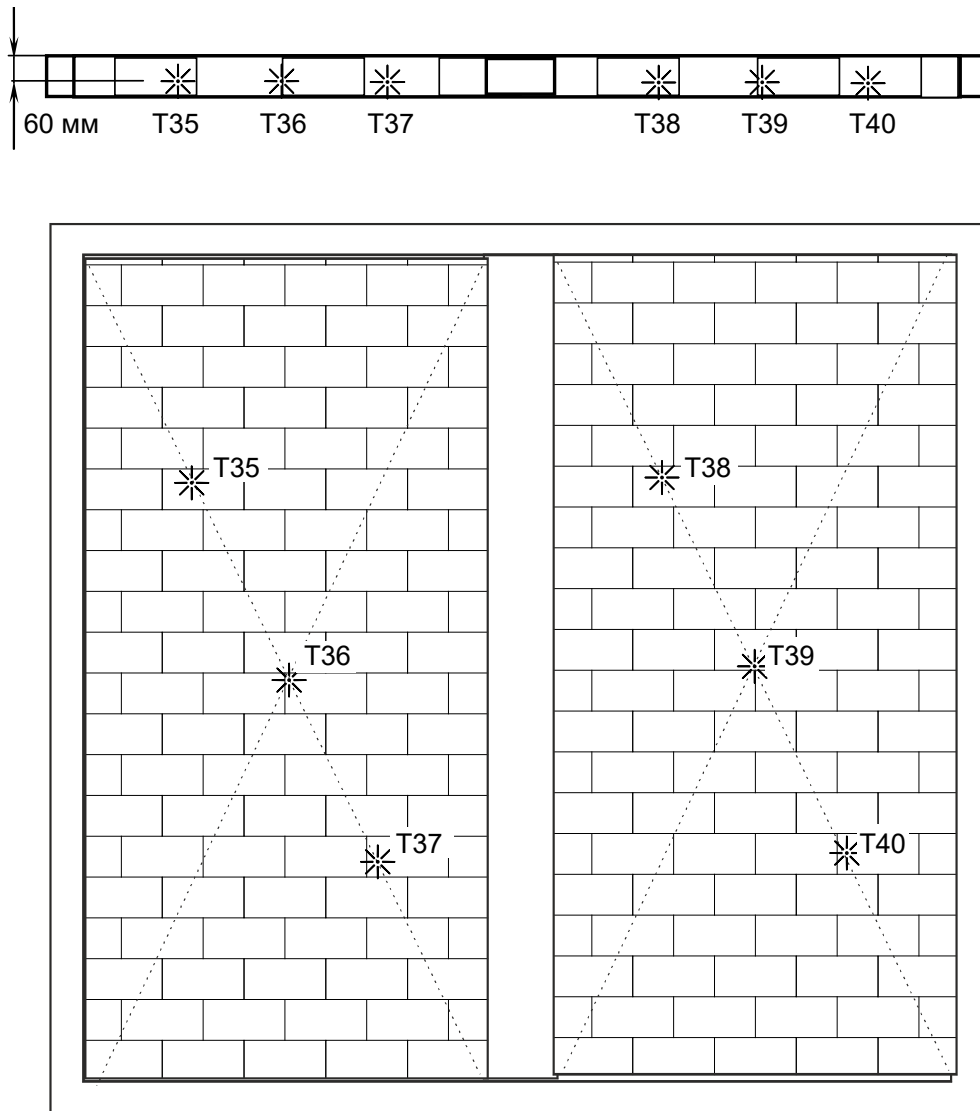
Схема розташування термопар у перерізі фрагментів стін-зразків з блоків із легкого бетону для випробувань.
